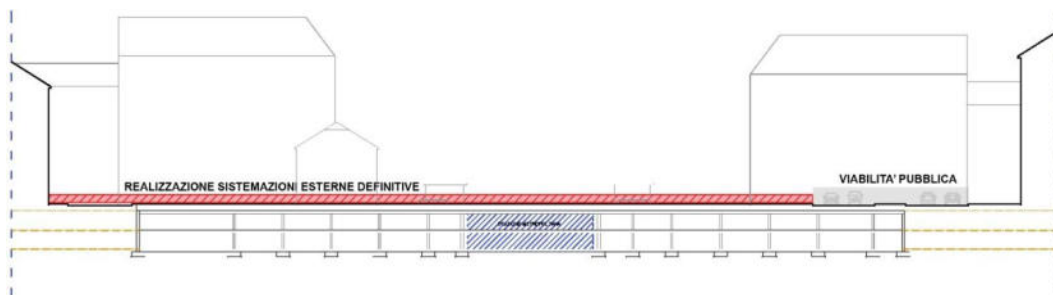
Pianta e sezione dell'organizzazione di layout per la Fase 3
